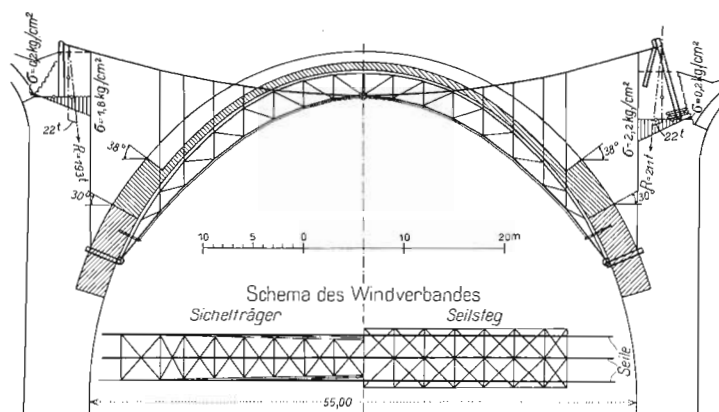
Projekt der Bauleitung zu einem eisernen Lehrgerüst für die Mittelöffnung des Wiesener Viaduktes. — 1 : 750.
